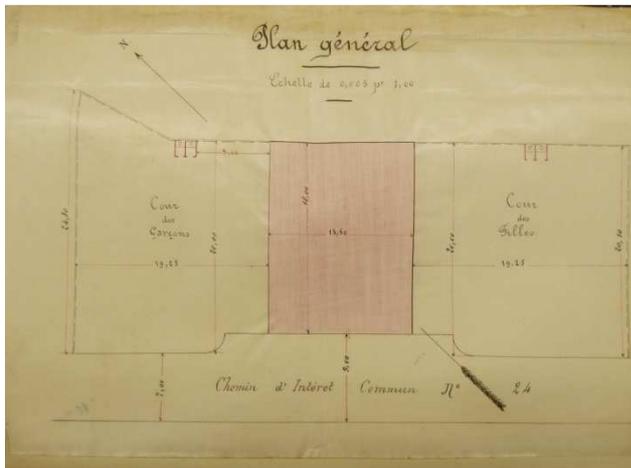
Projet de construction d'une maison d'école avec mairie, plan général, Angeli (conducteur des Ponts et Chaussées).
